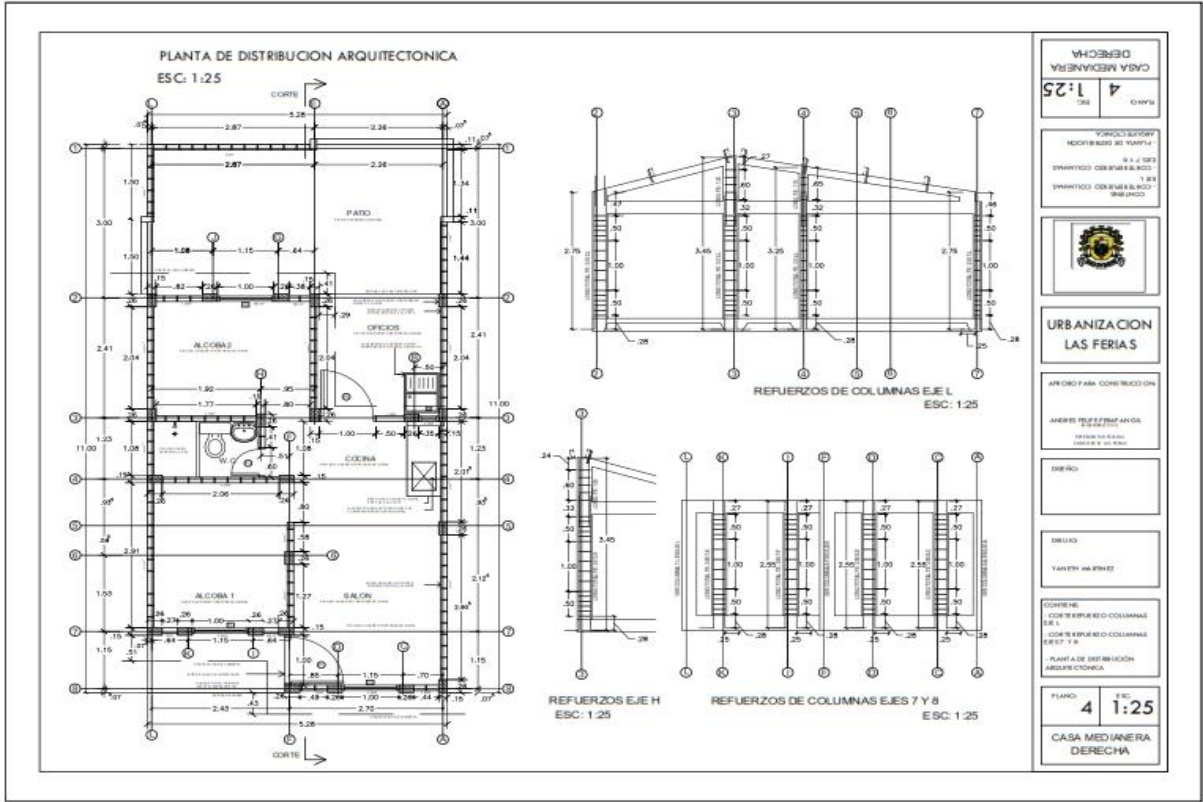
Planta de distribución arquitectónica, corte refuerzo columnas eje L 7 y 8
